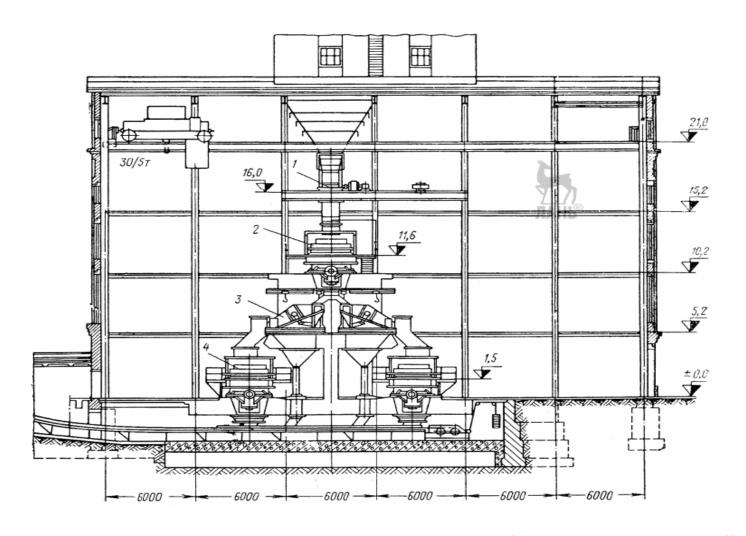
Корпус среднего и мелкого дробления с каскадной компоновкой дробилок (при соотношении) 1:2: 1 – пластинчатый питатель; 2 – конусная дробилка КСД-2200; 3 – инерционный грохот; 4 – конусная дробилка КМД-2200
